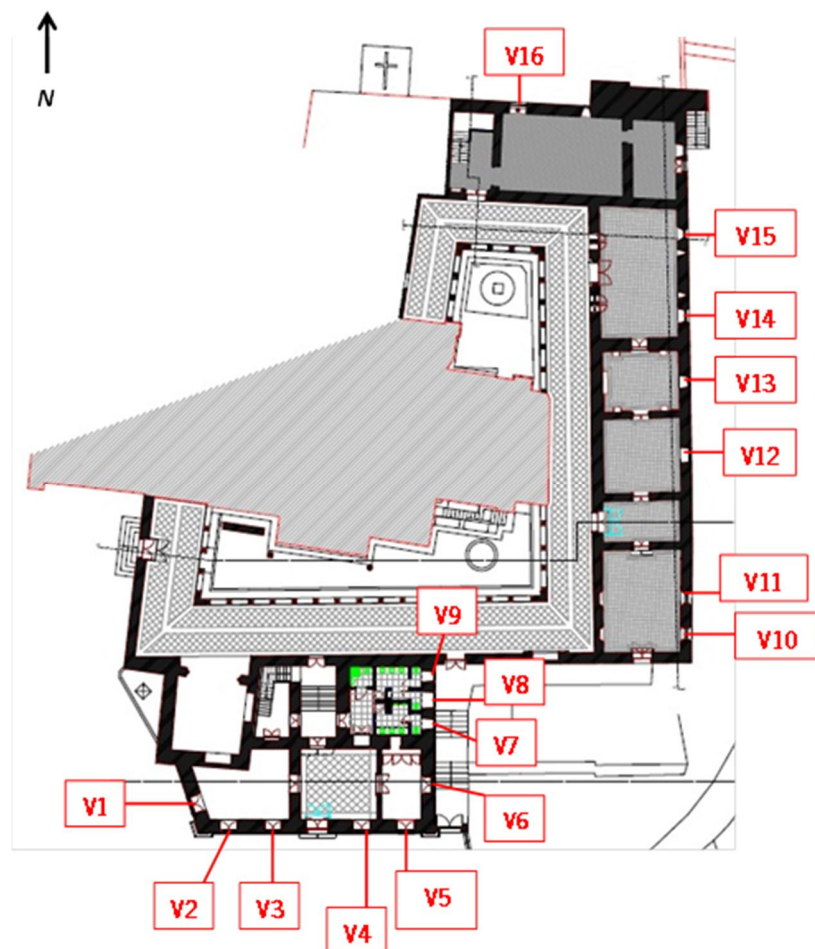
Localização dos diferentes vãos envidraçados na planta do Rés-do-chão. (Sem escala)
